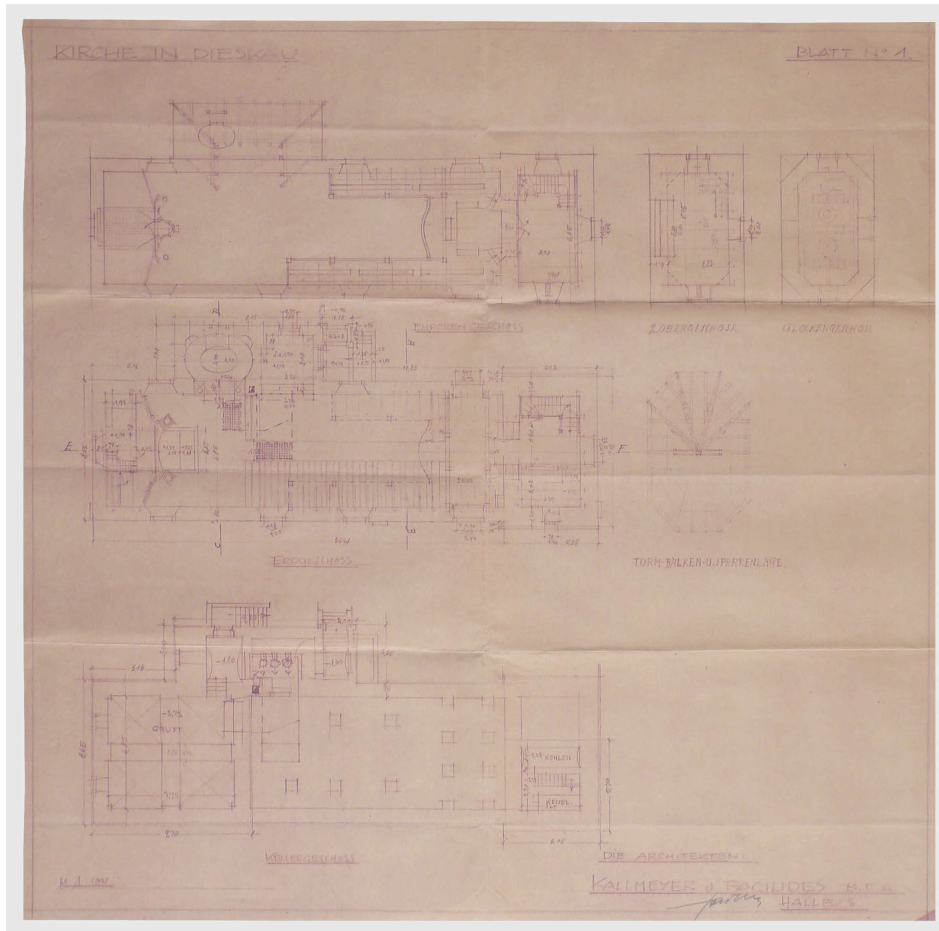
Evangelische Kirche St. Anna zu Dieskau, Grundrisse, datiert 1931.
